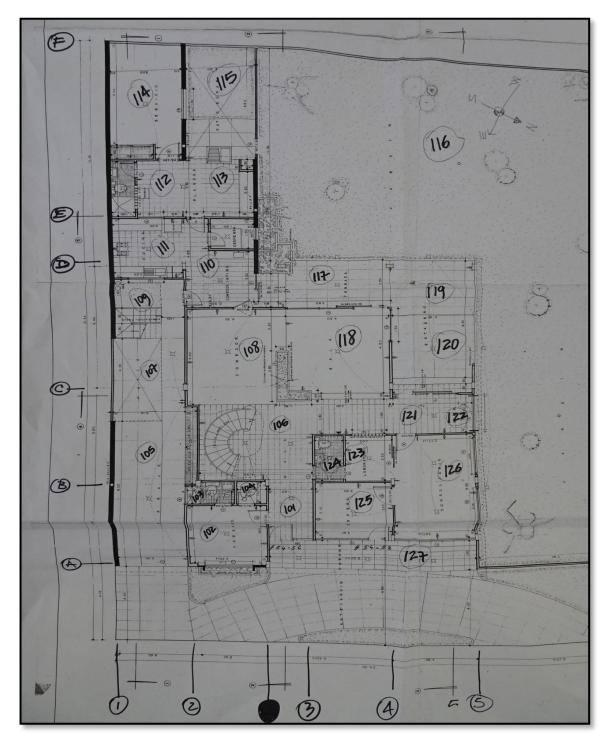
PLANO ARQUITECTÓNICO - PISO 1
